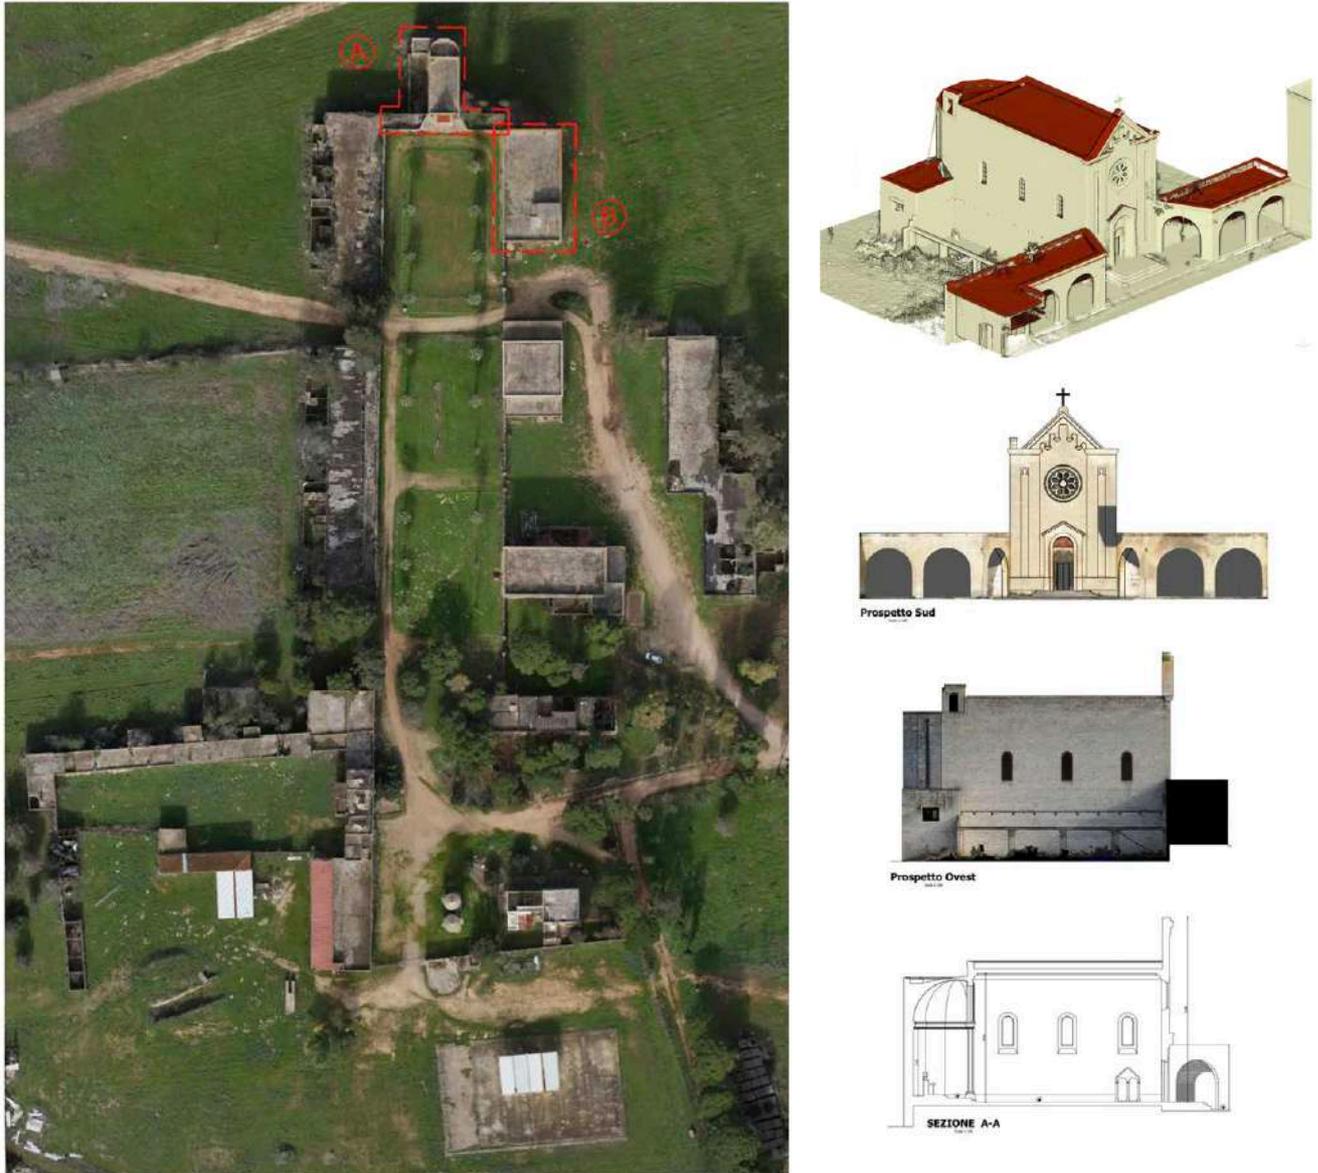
Immagini estratte dal rilievo plano altimetrico di dettaglio del Villaggio Monteruga
